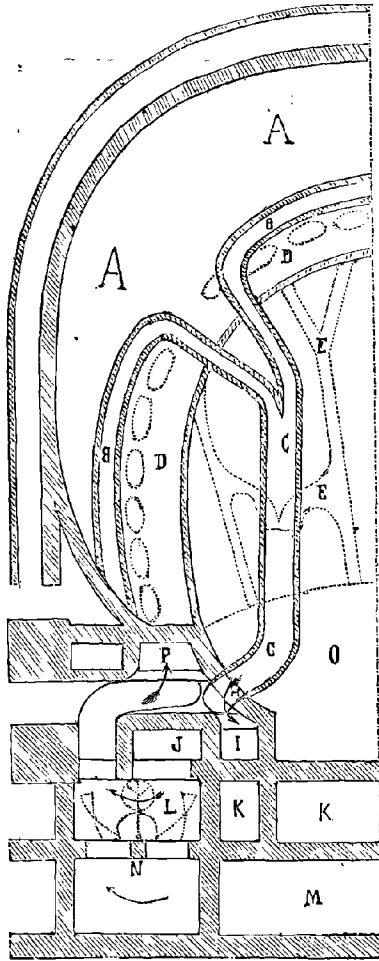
PLAN DE LA VENTILATION DE LA SALLE DES FÊTES AU PALAIS DU TROCADÉRO.
